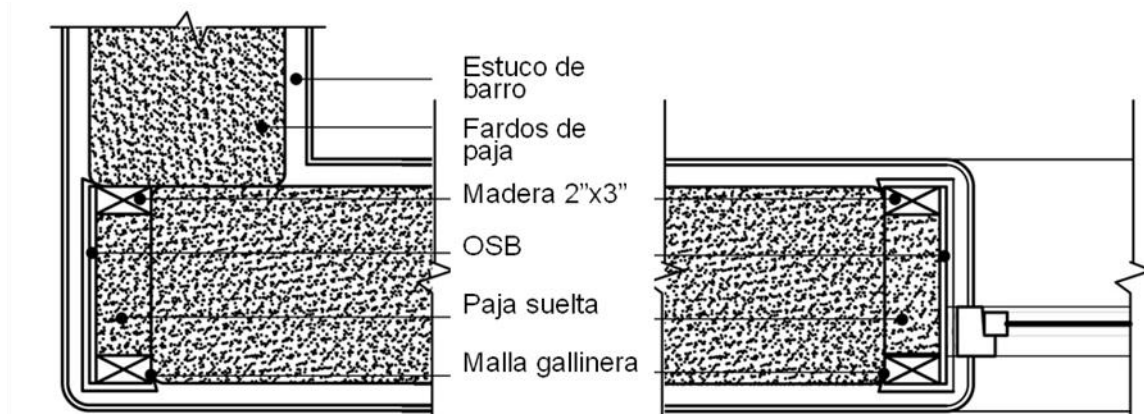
Detalle constructivo en planta del sistema constructivo con fardos de paja
